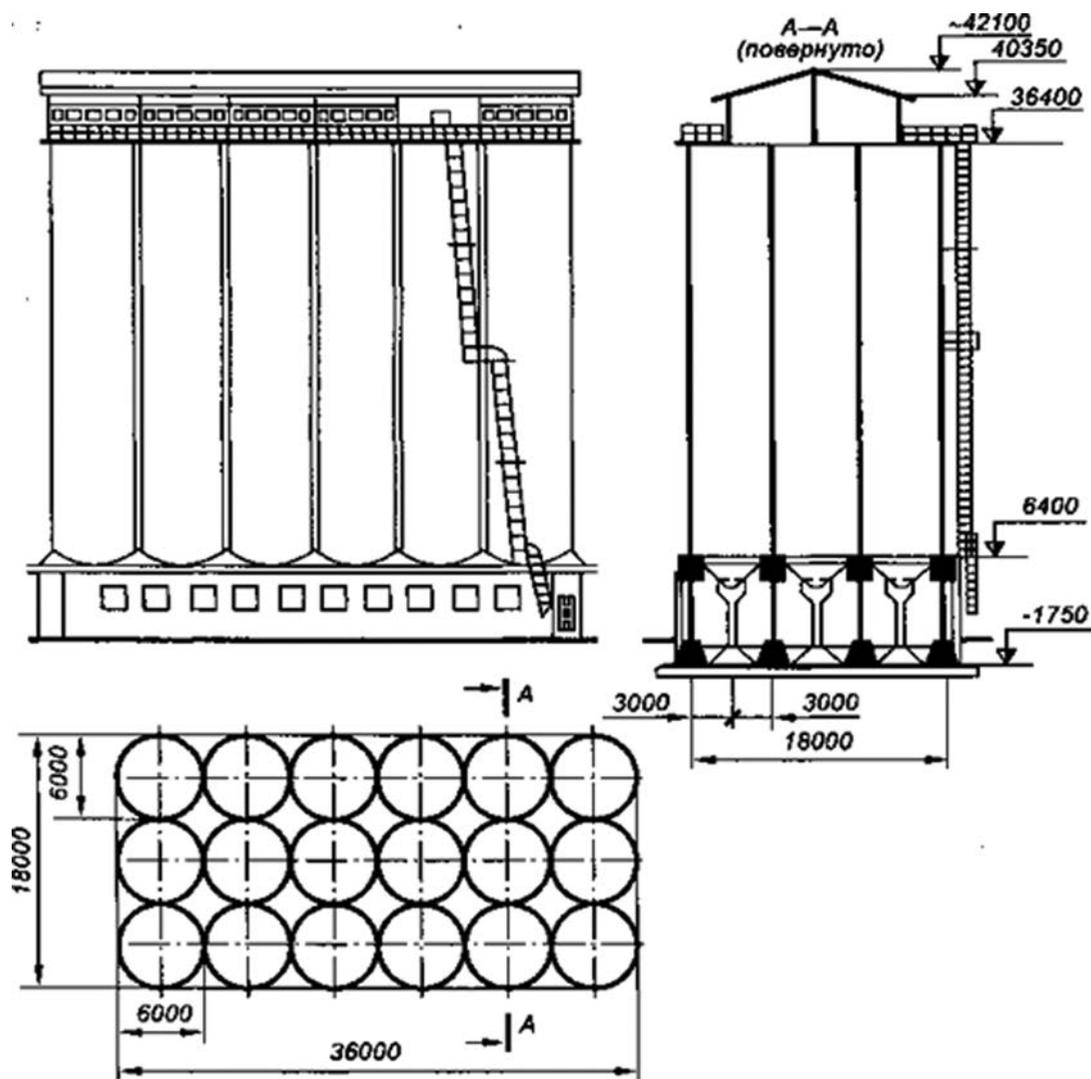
Схема элеваторного (силосного) корпуса
